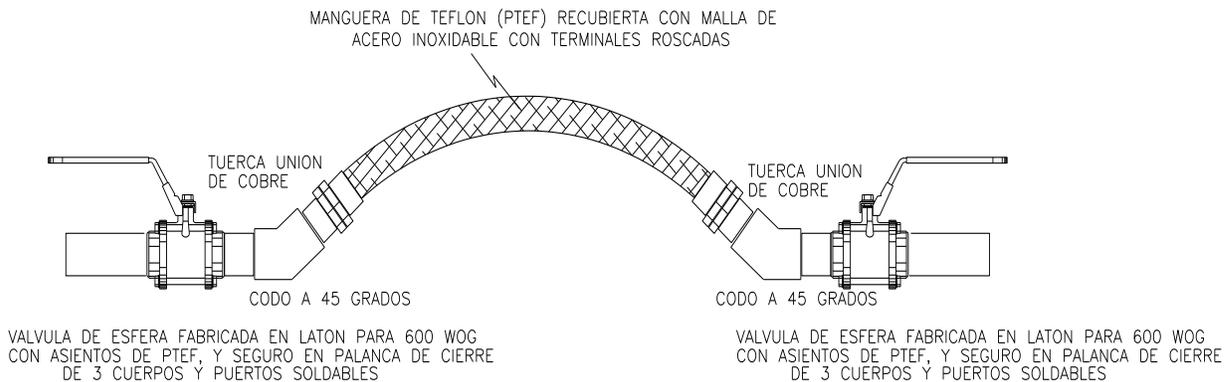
B.- Manguera Flexible en Junta Constructiva.
